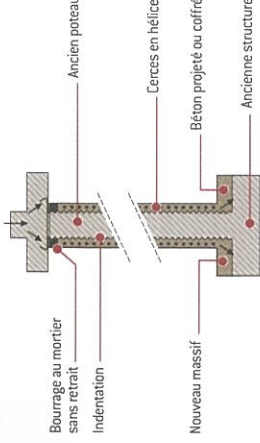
Chemisage en béton armé d'un poteau + fondation renforcée (coupe transversale)
